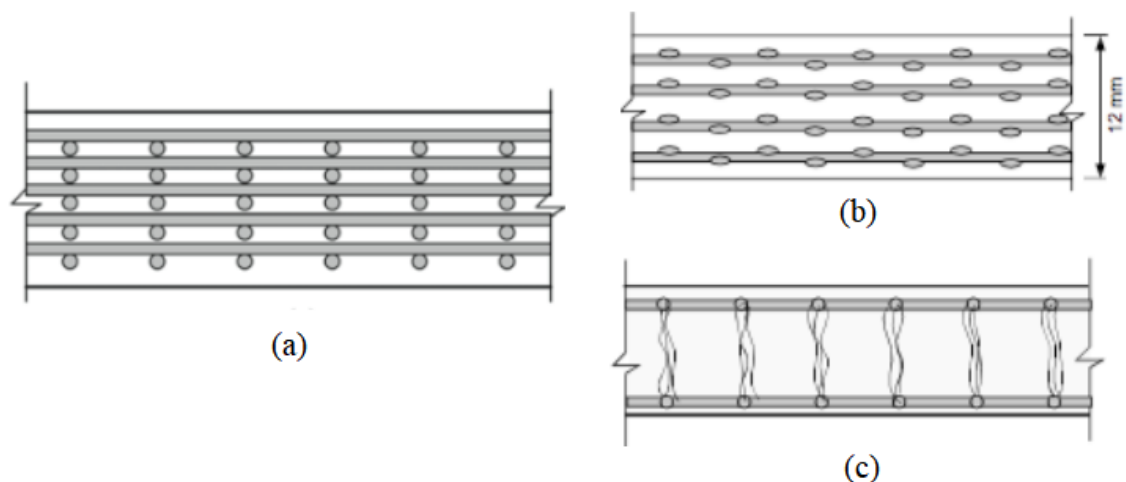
(a) Seção típica do ferrocimento com diversas camadas de malha e seções típicas de concreto têxtil com (b) diversas camadas de reforços de têxteis bidimensionais, ou (c) uma camada de têxtil tridimensional
